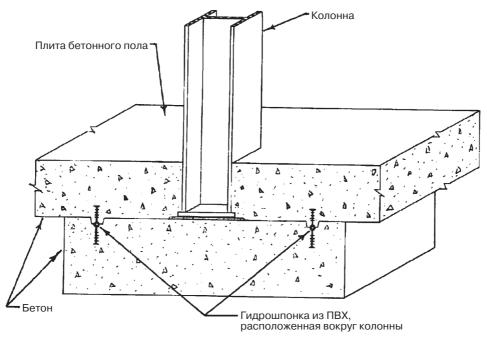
Установка гидрошпонки вокруг колонн фундамента из конструкционной стали (предоставлено AntiHydro)
